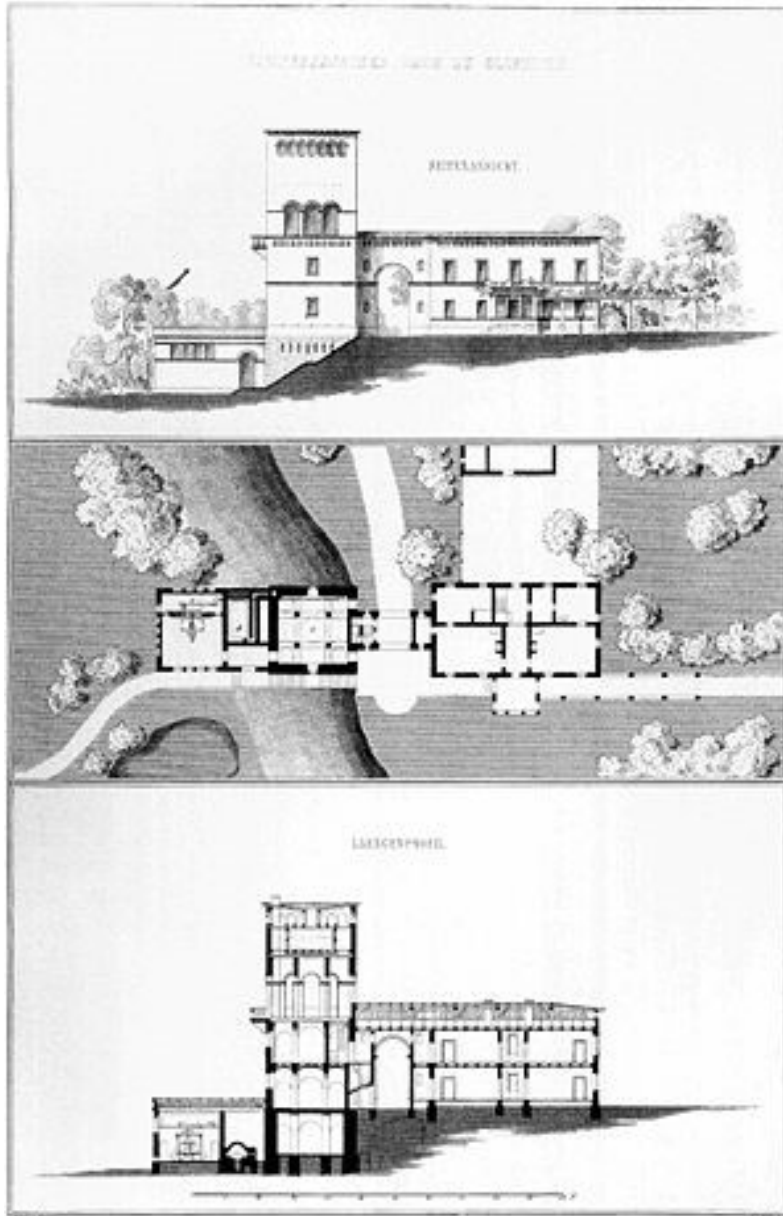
Ejemplo de planos de un Proyecto Arquitectónico. De arriba hacia abajo: representación en alzado o elevación, una planta del edificio y corte o sección longitudinal
